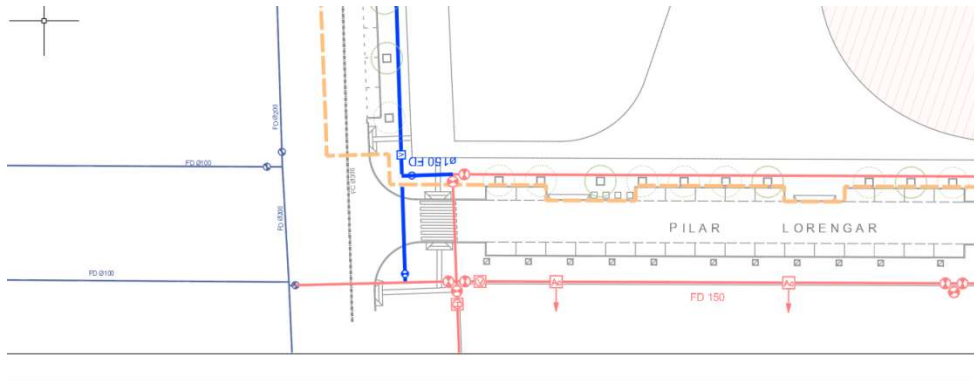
Punto de conexión en la intersección de Camino de la Térmica con Calle Pilar Lorengar.
